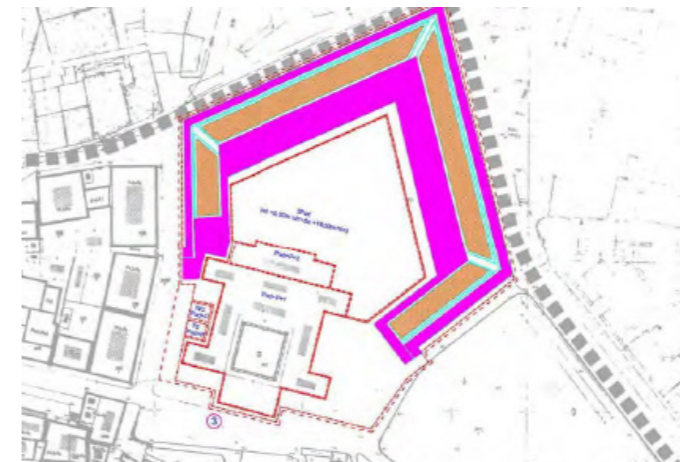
Bebauungsplan für den alten Stadtkern, 2006
